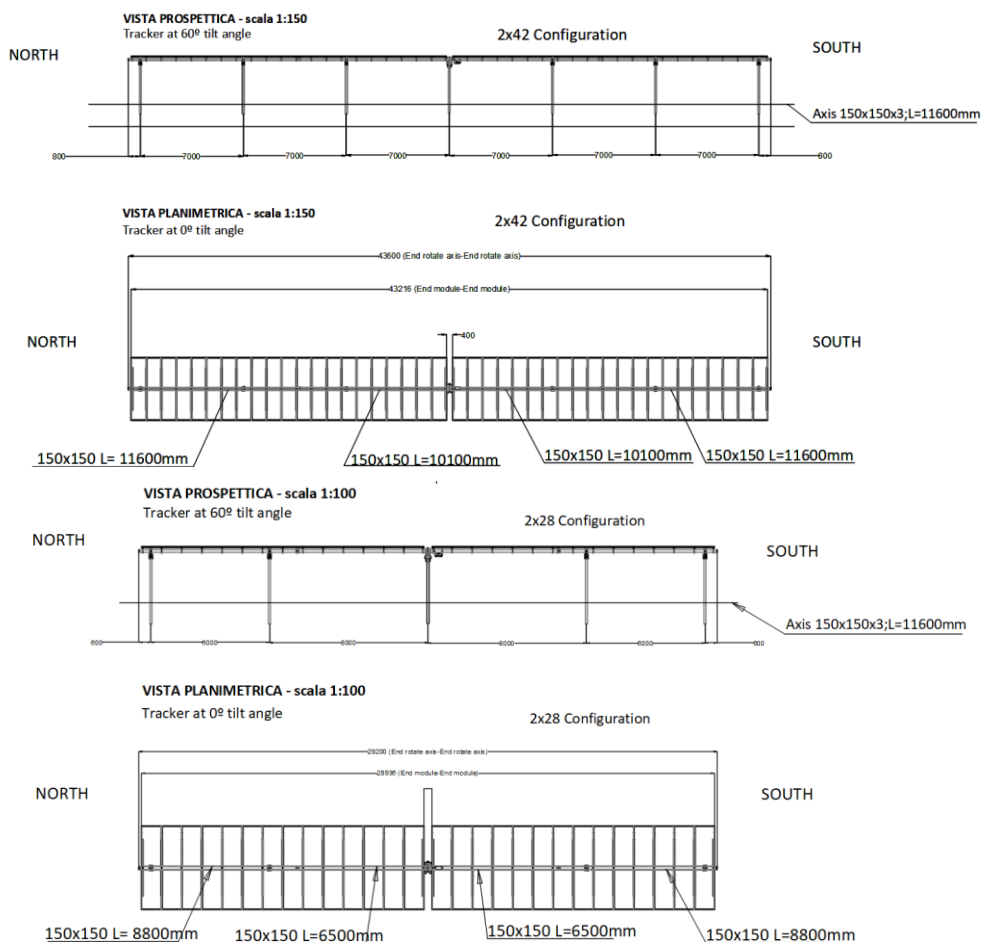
Vista prospettica e planimetrica delle strutture porta-moduli tracker 2x42 e 2x28
